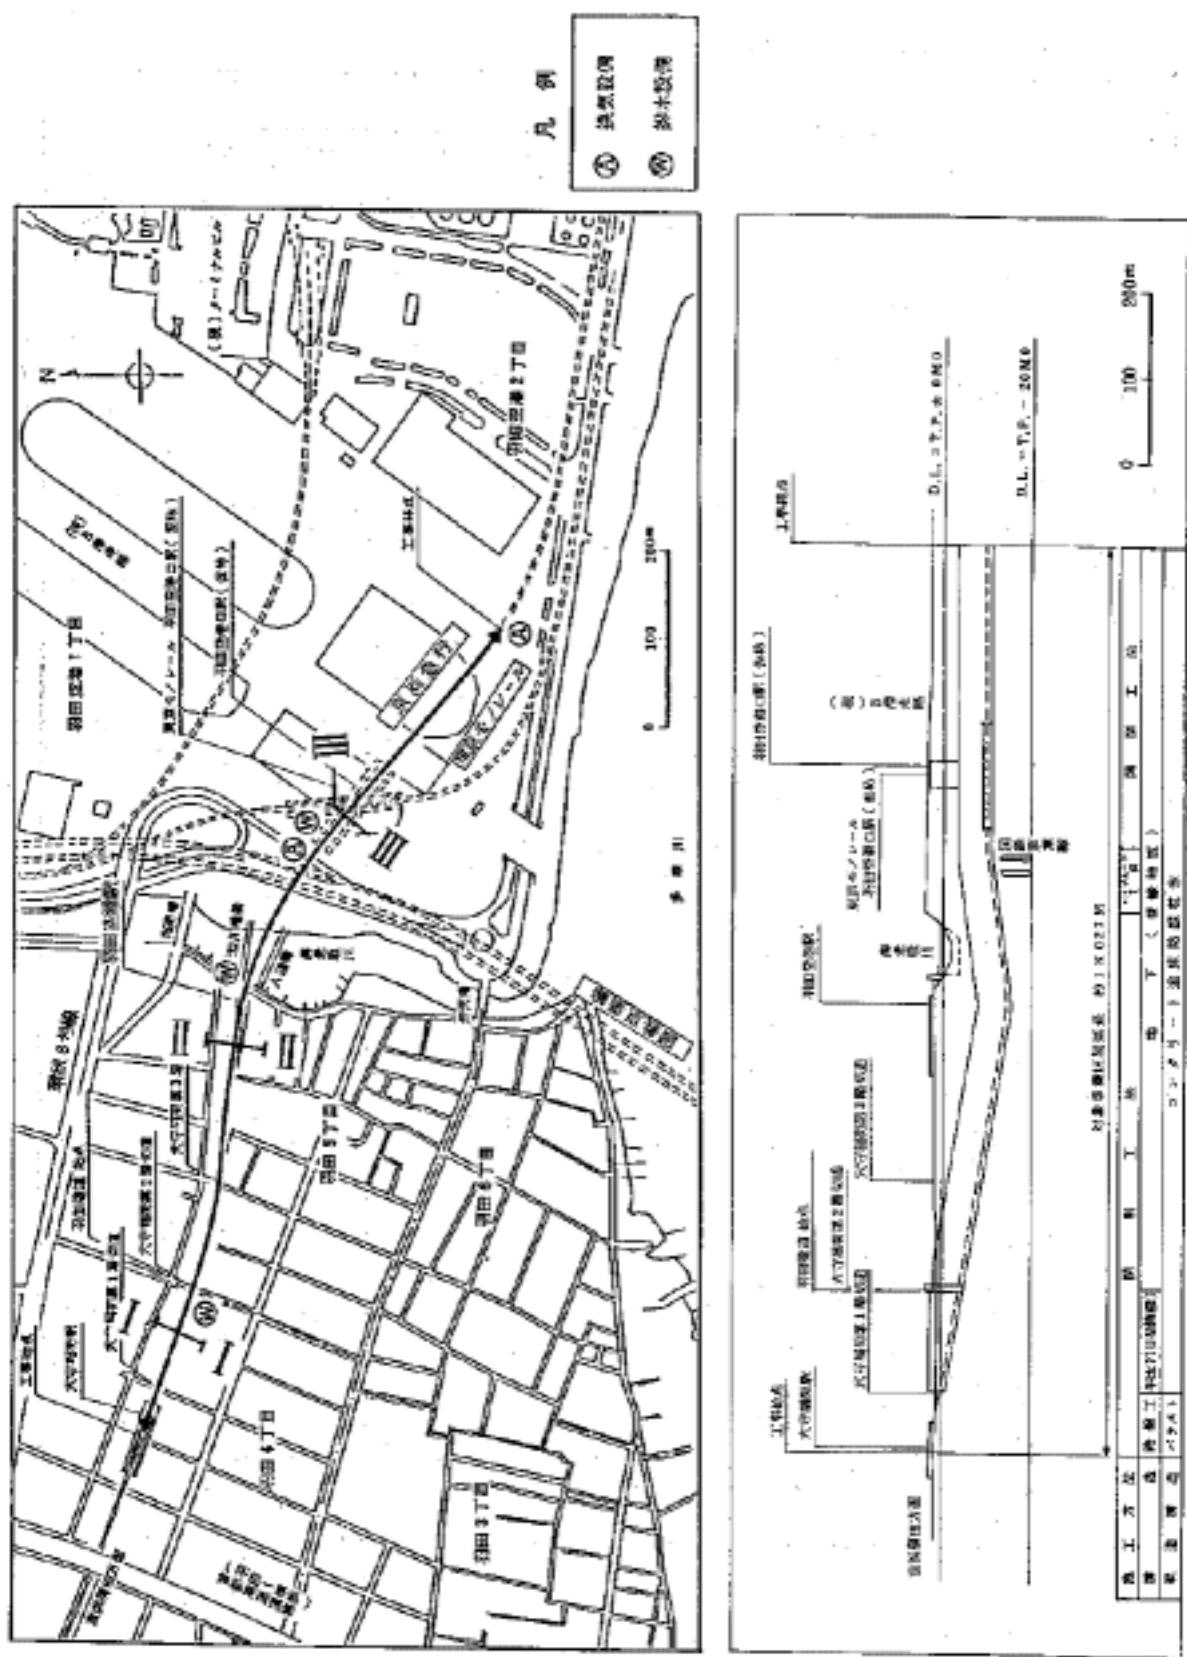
対象事業の路線区間平面図及び縦断面図
